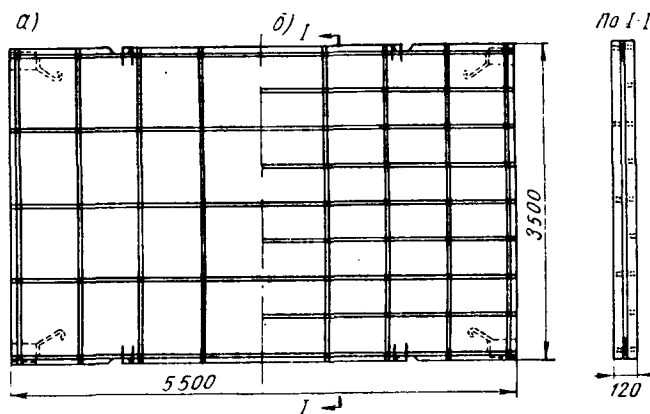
Армирование струнубетонной плиты сборного покрытия:
